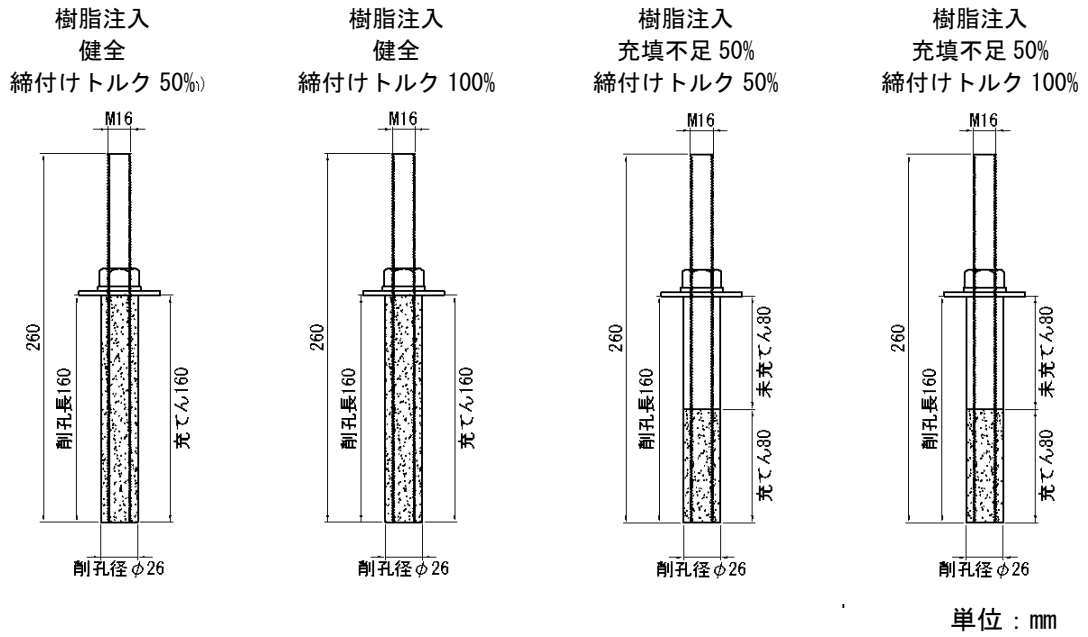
あと施工アンカー施工図（樹脂注入トルク導入）
